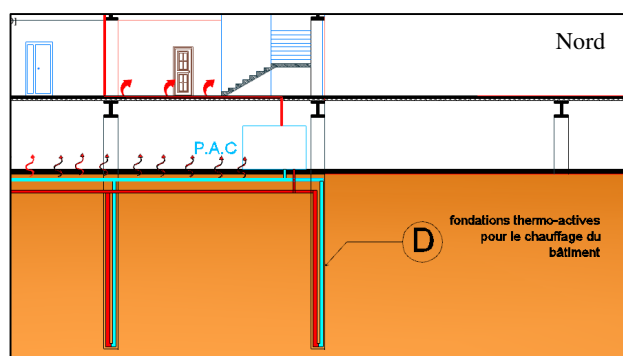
zoom sur les pieux thermoactifs en hiver Coupe B-B
